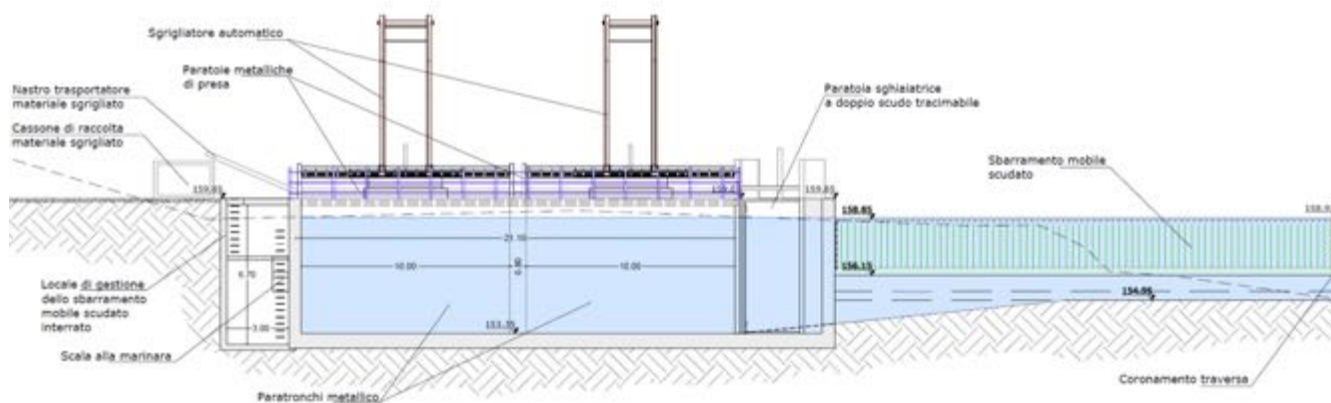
Sezione impianto in corrispondenza dello sbarramento
